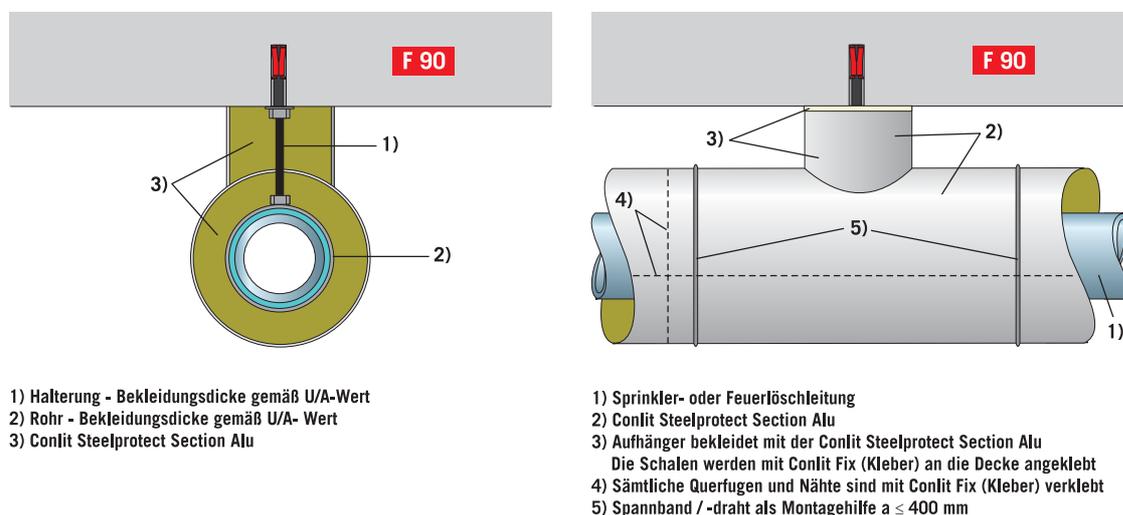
Bekleidung von Feuerlösch- und Sprinklerleitungen
